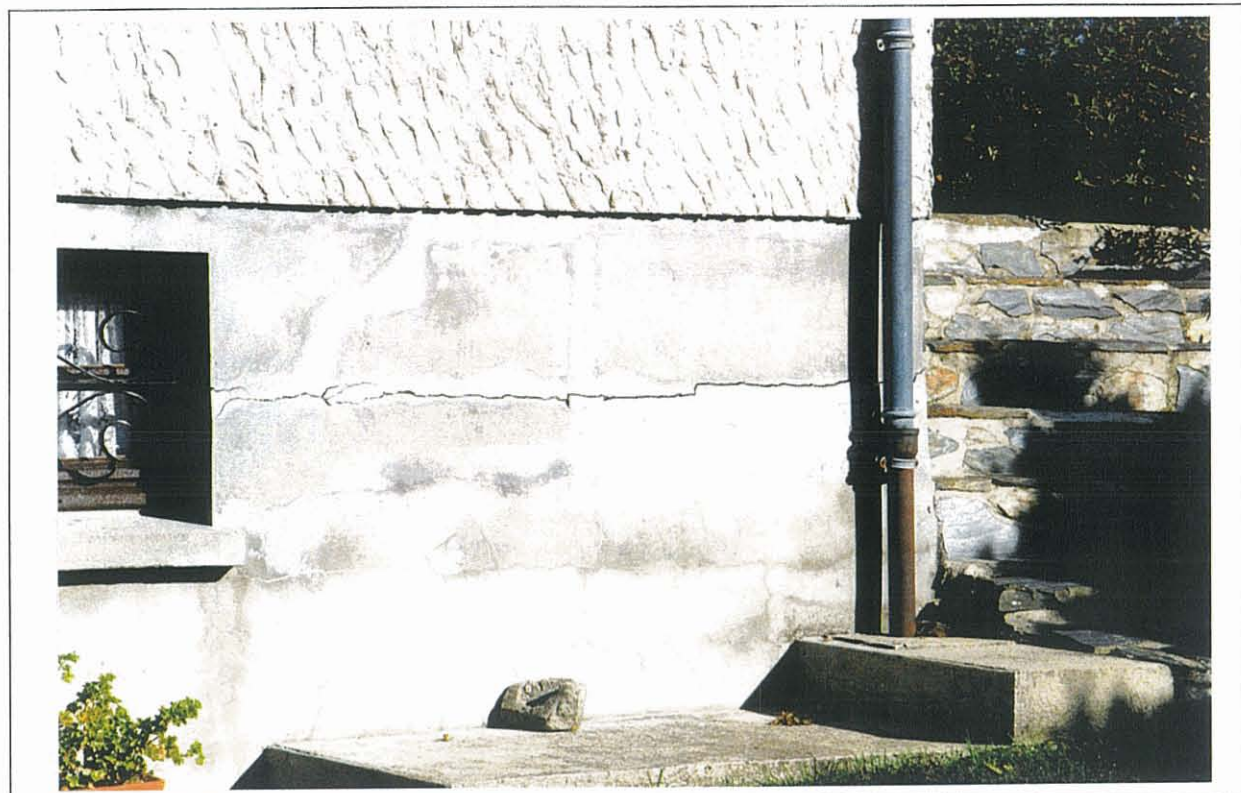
Lézarde horizontale entre fenêtre et escalier
